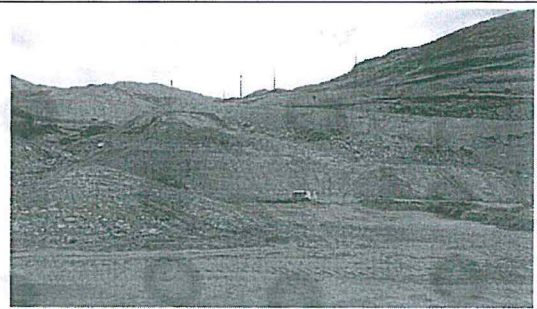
Trabajo de retiro de top soil, finalizado.
